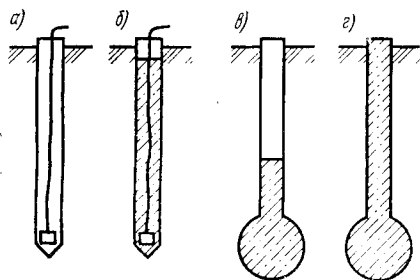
Изготовление камуфлетных свай в неизвлекаемой оболочке:
